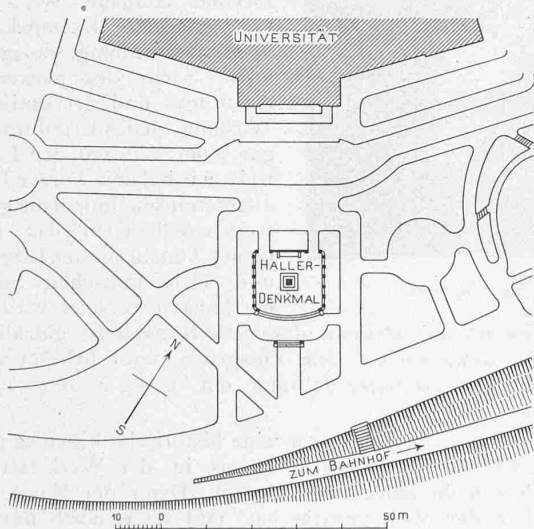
Lageplan des Haller-Denkmal in Bern. — 1:1500.
